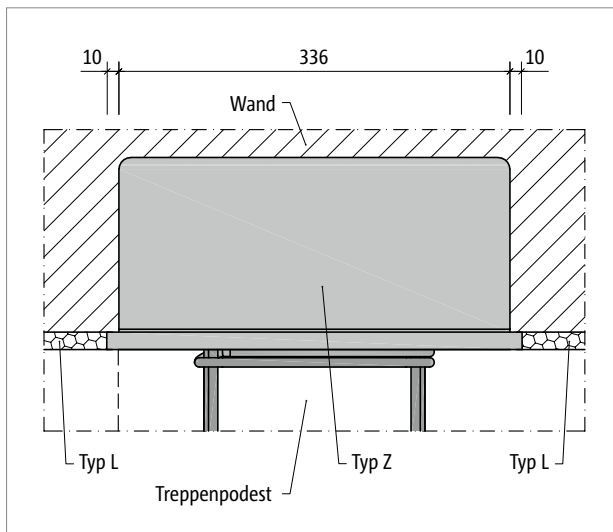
Schöck Tronsole® Typ Z: Elementanordnung, Detail A
